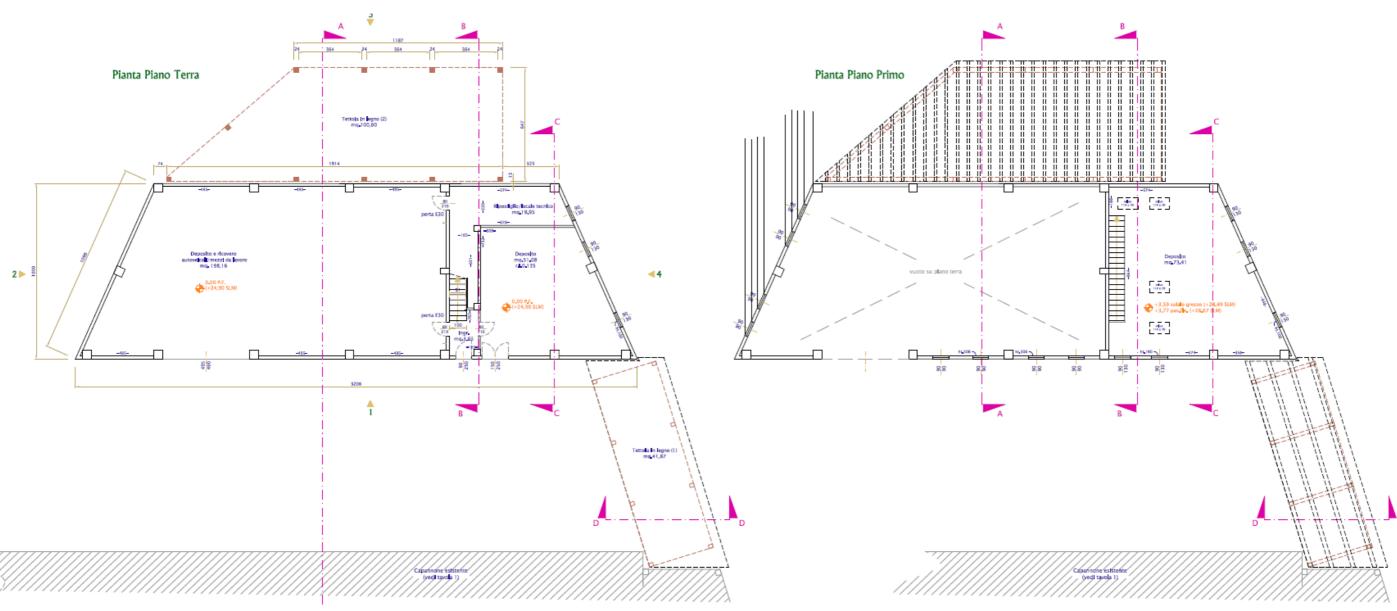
Planimetria complessiva-attuale-progetto
